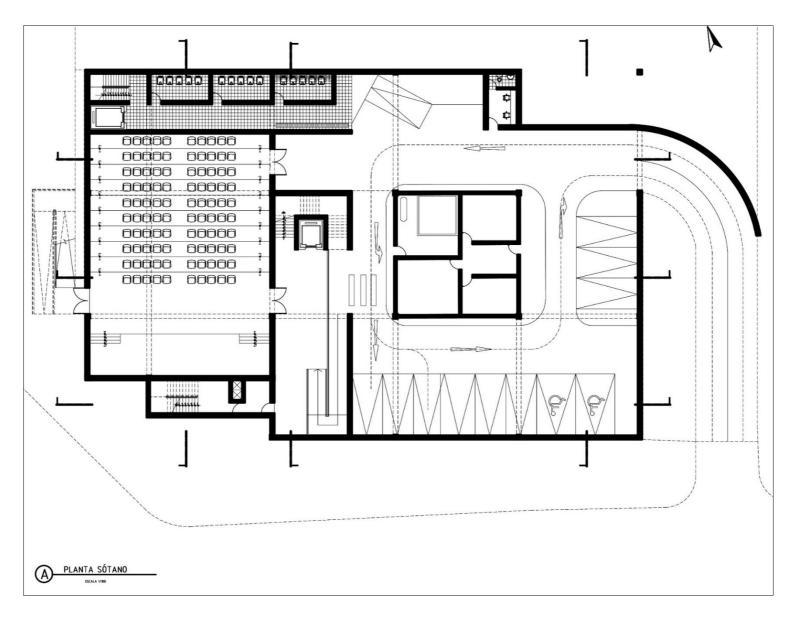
Planta de distribución - Sótano Fuente: elaboración propia
